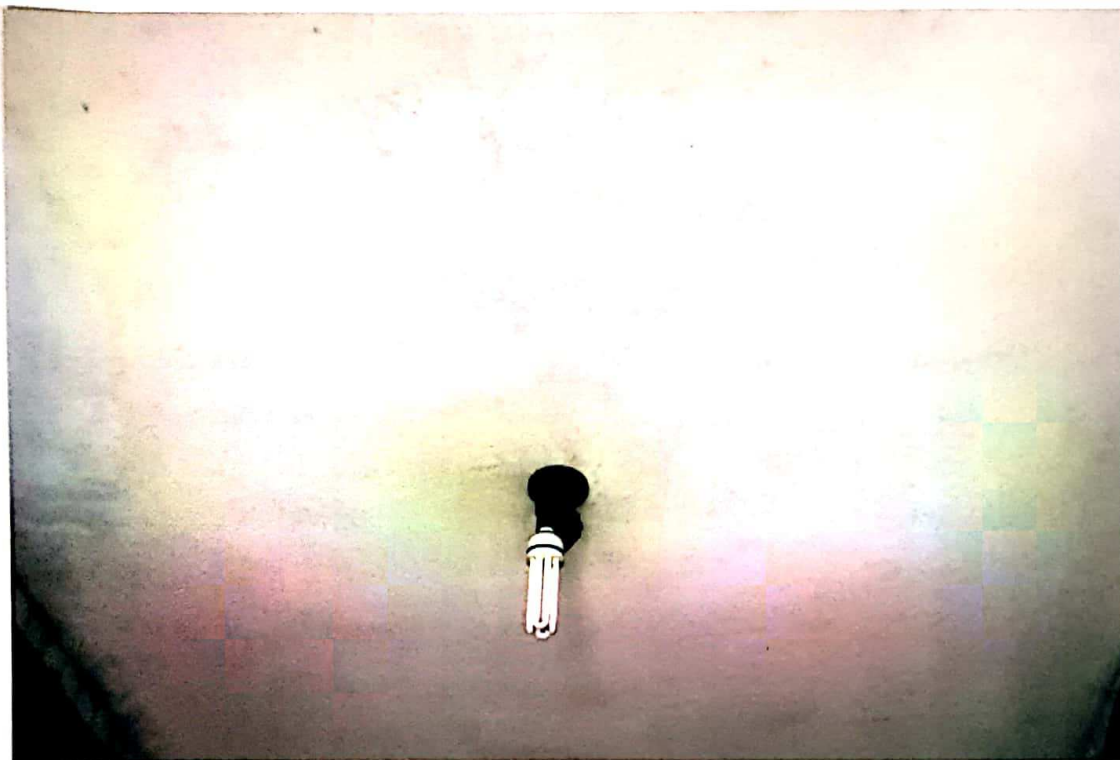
Detalhe do forro de laje de concreto da loja nº 02, com massa corrida e látex.
